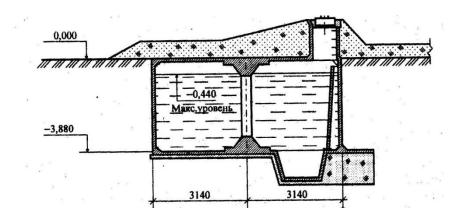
Закрытый цилиндрический монолитный резервуар
